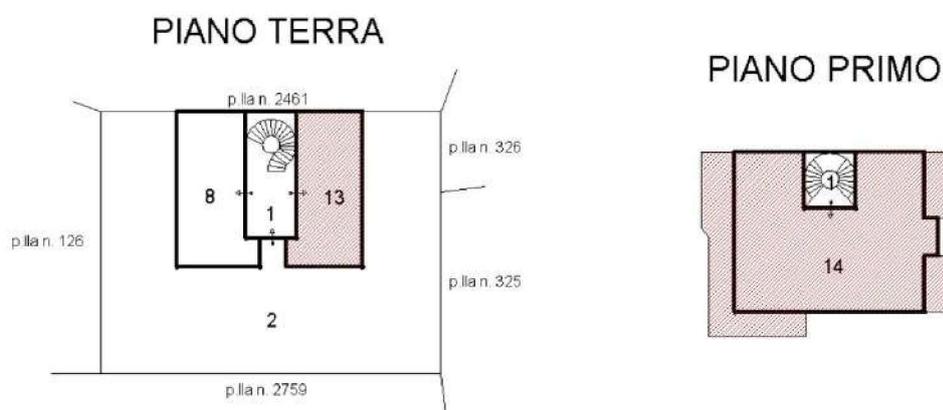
Individuazione subalterni (Porzione di Elaborato planimetrico prot. n. RC0090711 del 05/09/2019)
